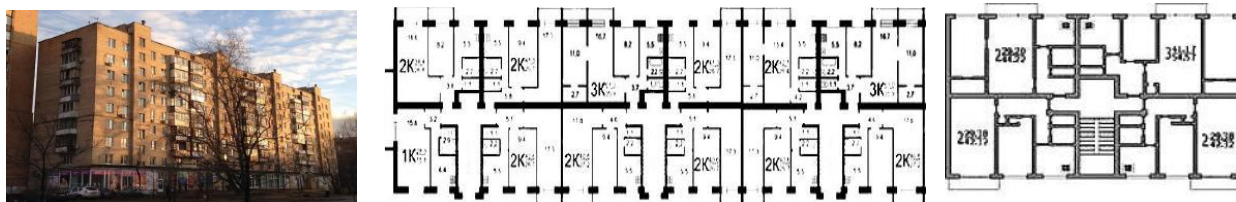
Пример кирпичного дома серии П-29, Москва 1966 г. Общий вид, план типового этажа, план жилых секций
